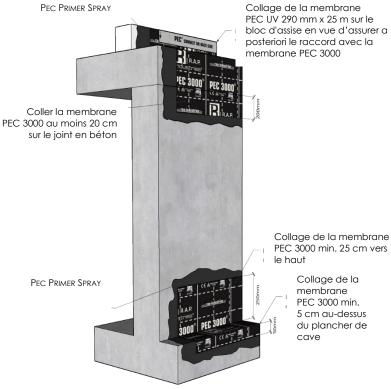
Application de la membrane PEC 3000® sur des caves en béton coulé ou préfabriqué
